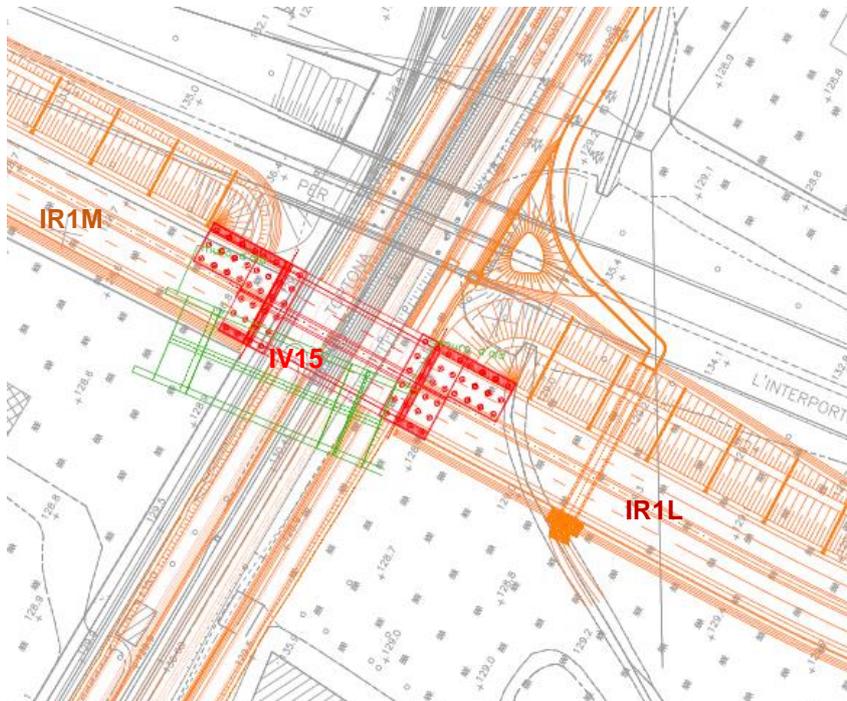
Localizzazione del cavalcaferrovia IV15 nel progetto approvato (in colore verde) ed in variante (colore rosso)
